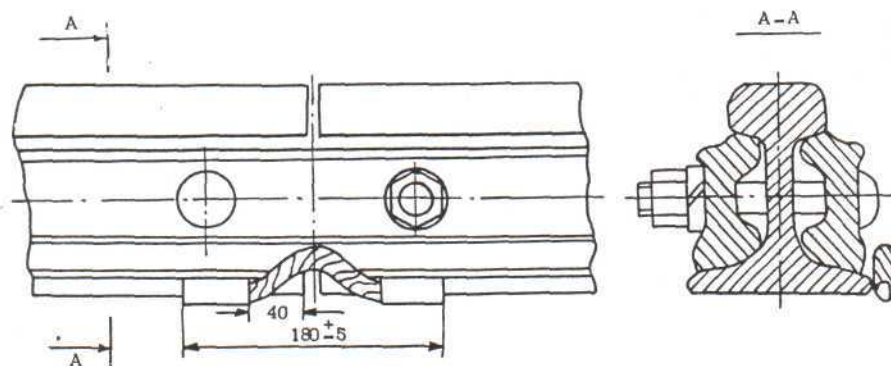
а. Приварка типового соединителя к боковой кромке подшвы объемно закаленных рельсов Р75
